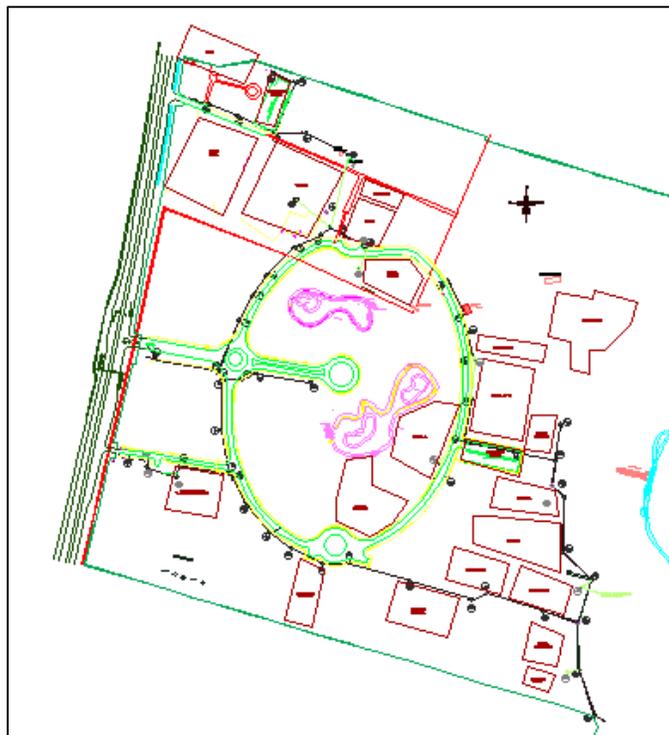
Plano actualizado de cruces de las redes de alcantarillado.
